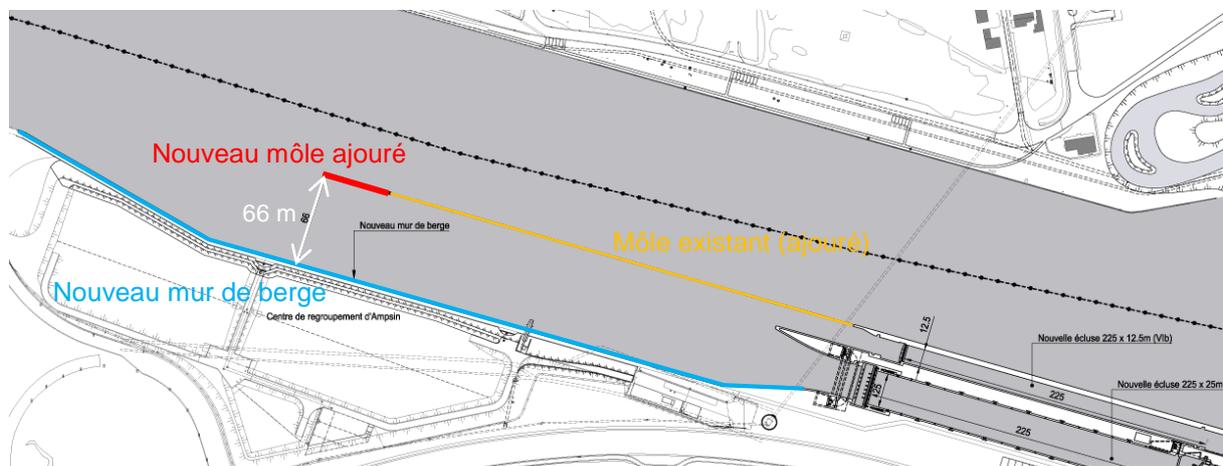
Avant-port amont en situation projetée (source : plan des auteurs de projet)
